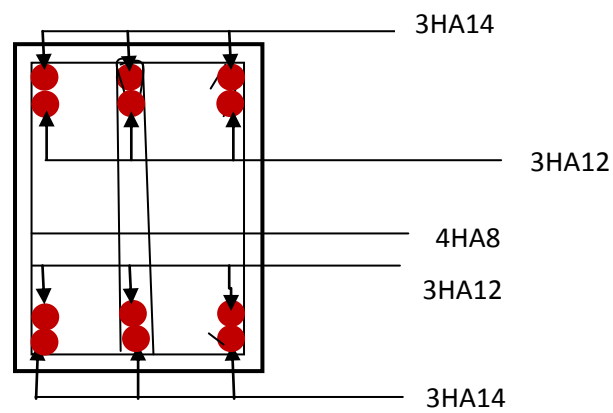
Ferrailage en travée d'une poutre secondaire.
